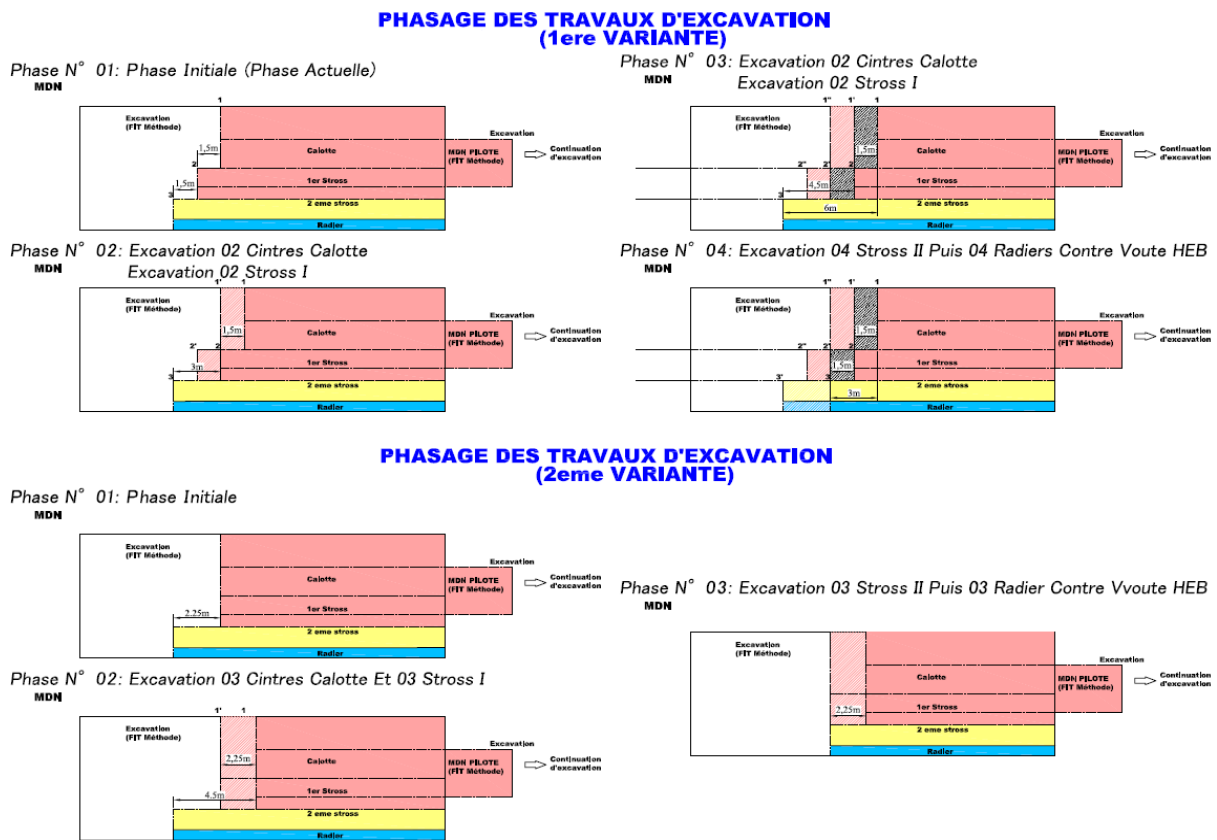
Phasage des travaux d'excavation du tunnel T4
